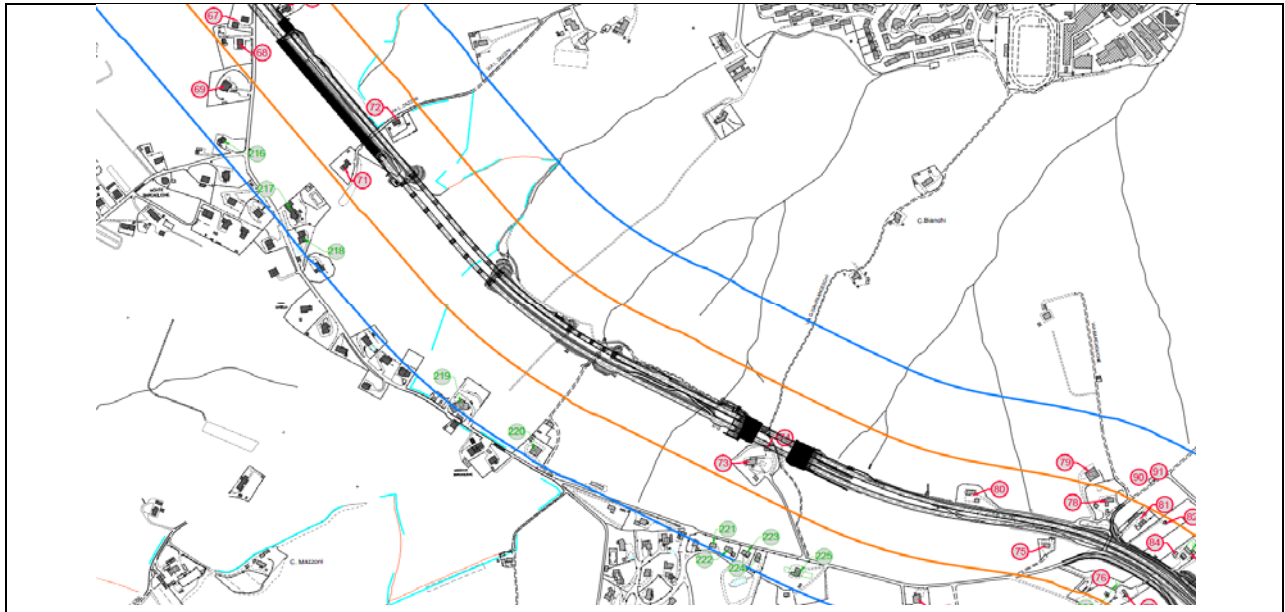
Estratto della planimetria di localizzazione, dei ricettori censiti e della zonizzazione acustica - Tav. 2 - Galleria Barcaglione
